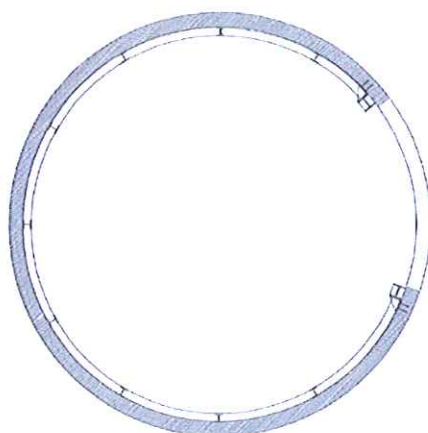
Tăierea segmentelor *tunelului de metrou
